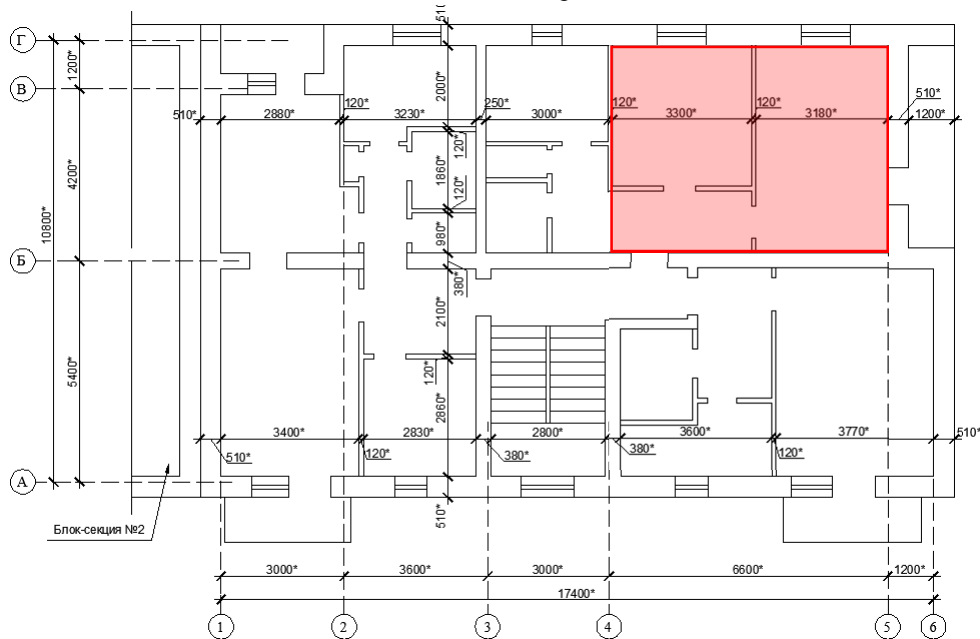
План третьего этажа здания блок-секции №3 с указанием места взрыва (Луганская обл., г. Стаханов, ул. Макарова, 3а.) / Plan of the third floor of the building, block-section No.3 with location of explosion (3a Makerova street, Stakhanov city, Luganskaya oblast)
